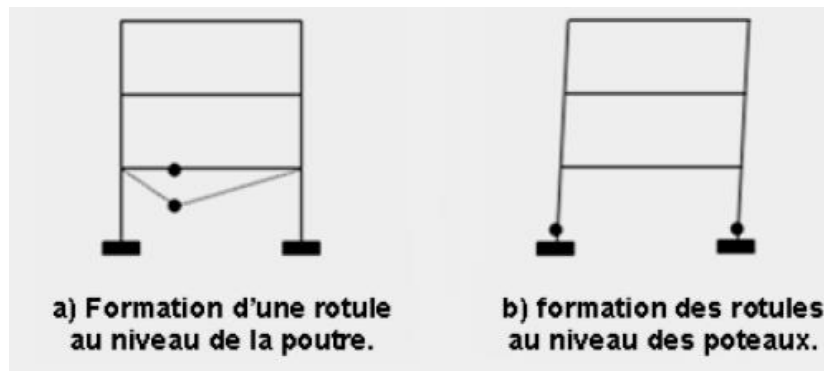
Positionnement des rotules plastiques dans les poteaux et les poutres.
